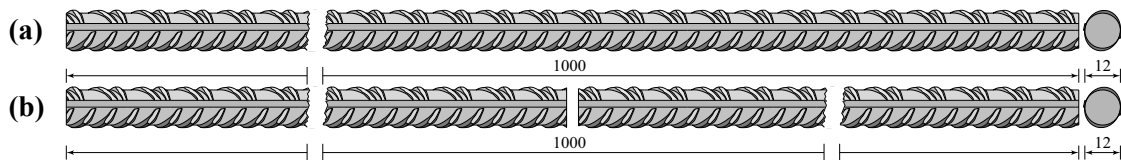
(a) Intakter und (b) gebrochener Bewehrungsstab. Abmessungen in mm.
